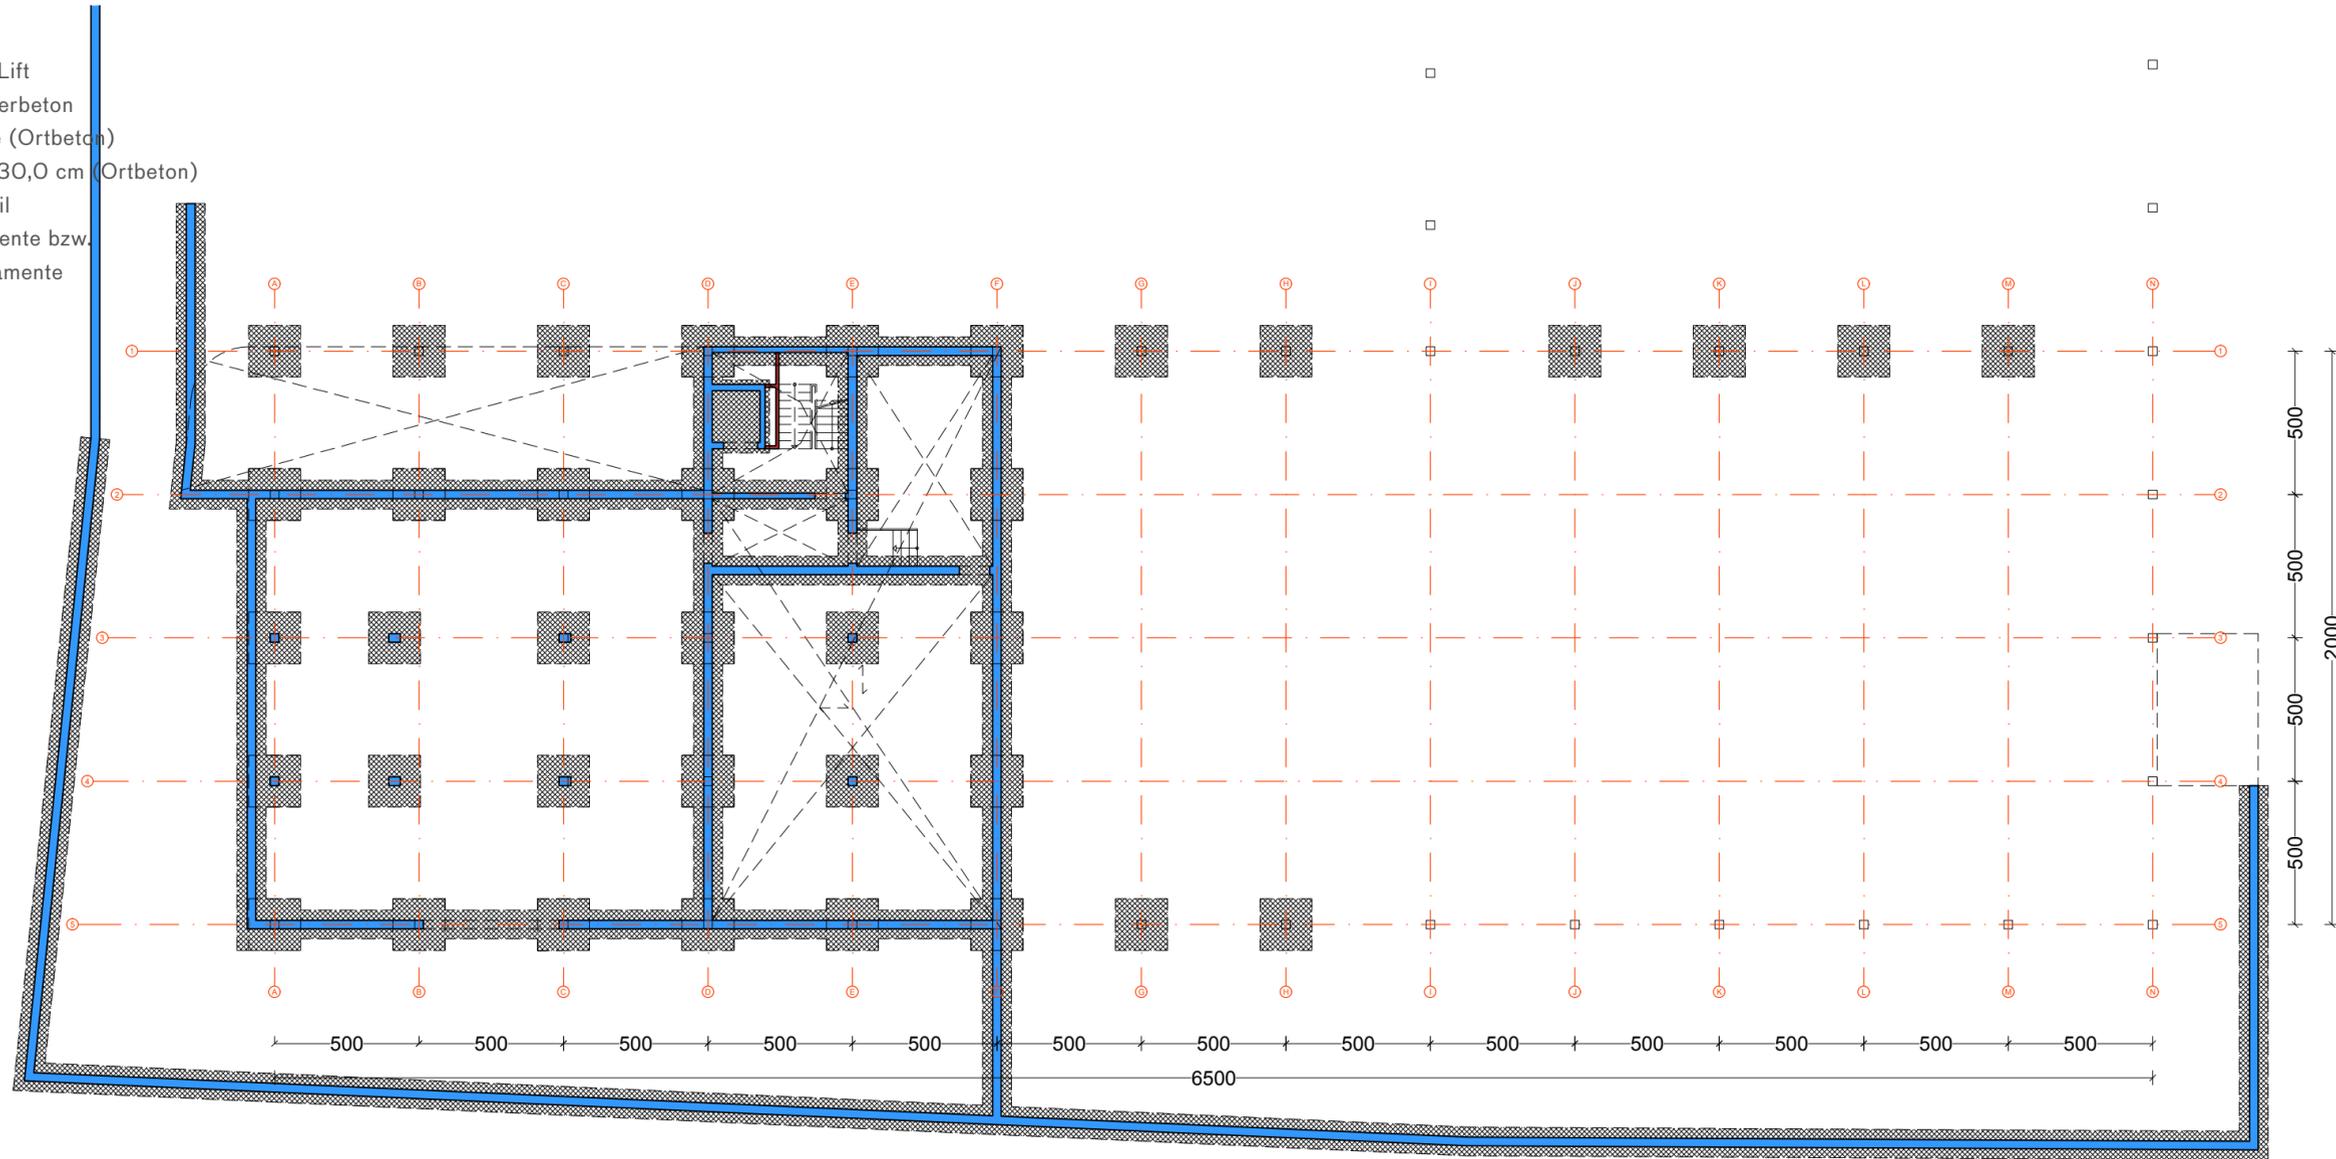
Tragwerksplan und Schalungsplan Kellergeschoß M 1.200
